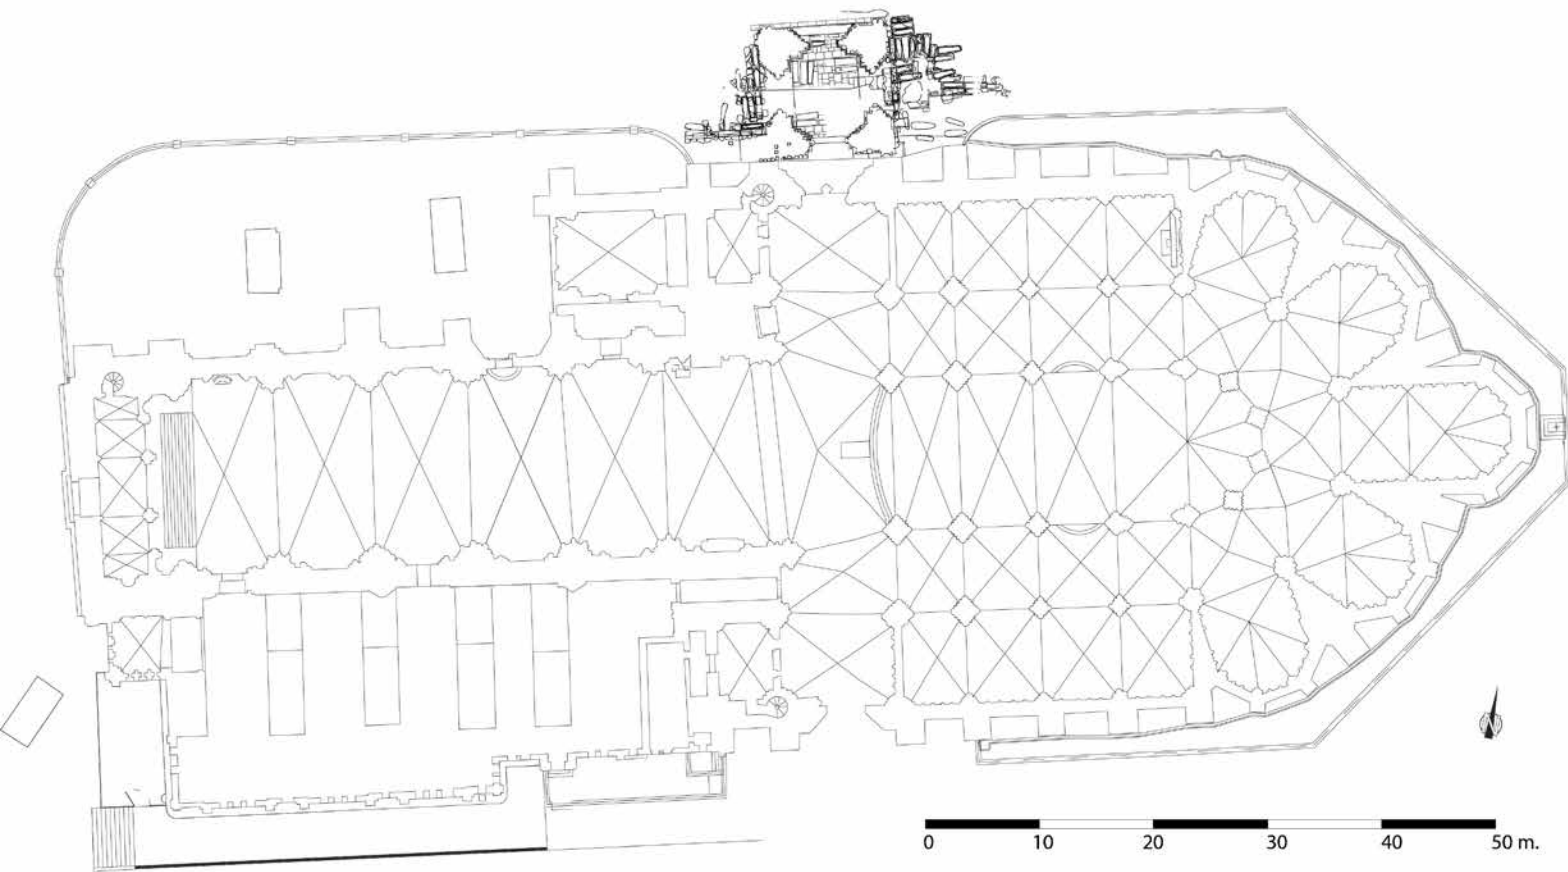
Repositionnement de la tour-porche par rapport au plan de la cathédrale actuelle.
